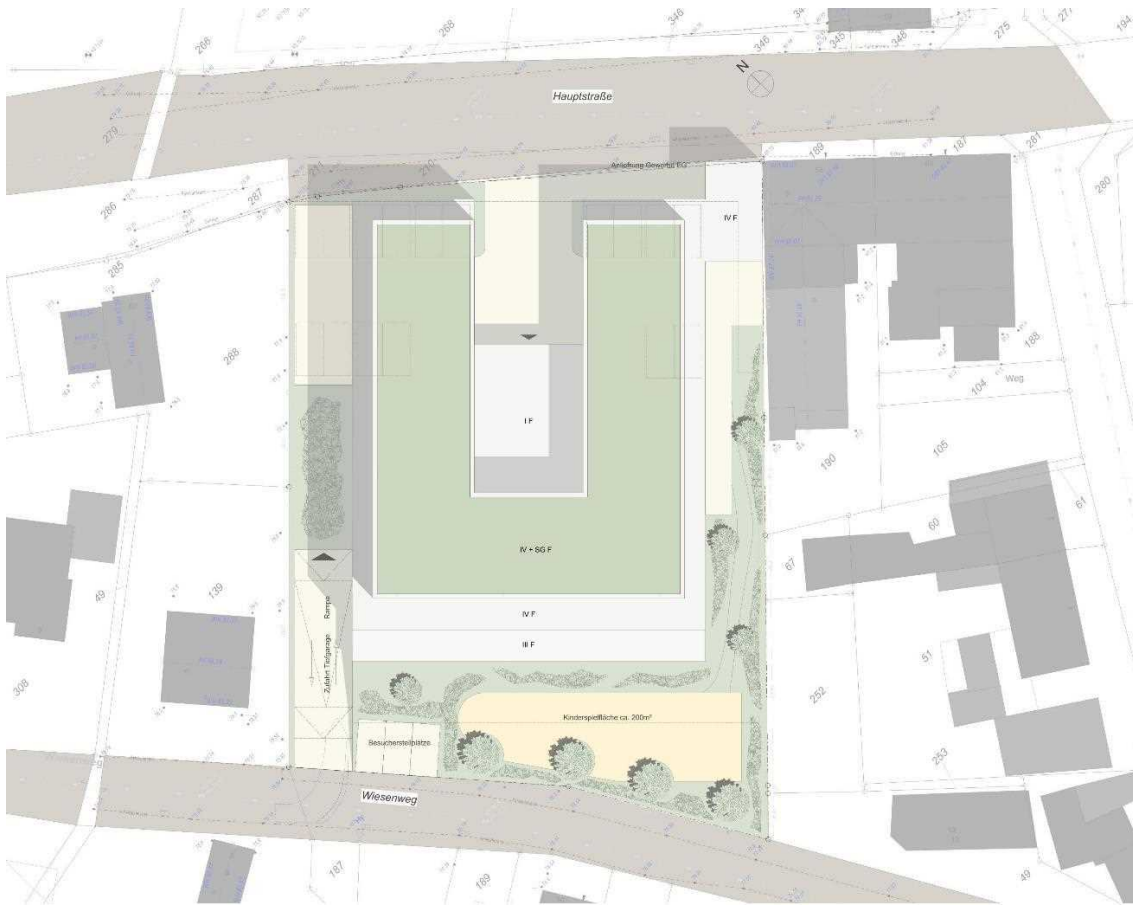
Lageplan - GL Projekt GmbH, VIS Architekten, April 2026
